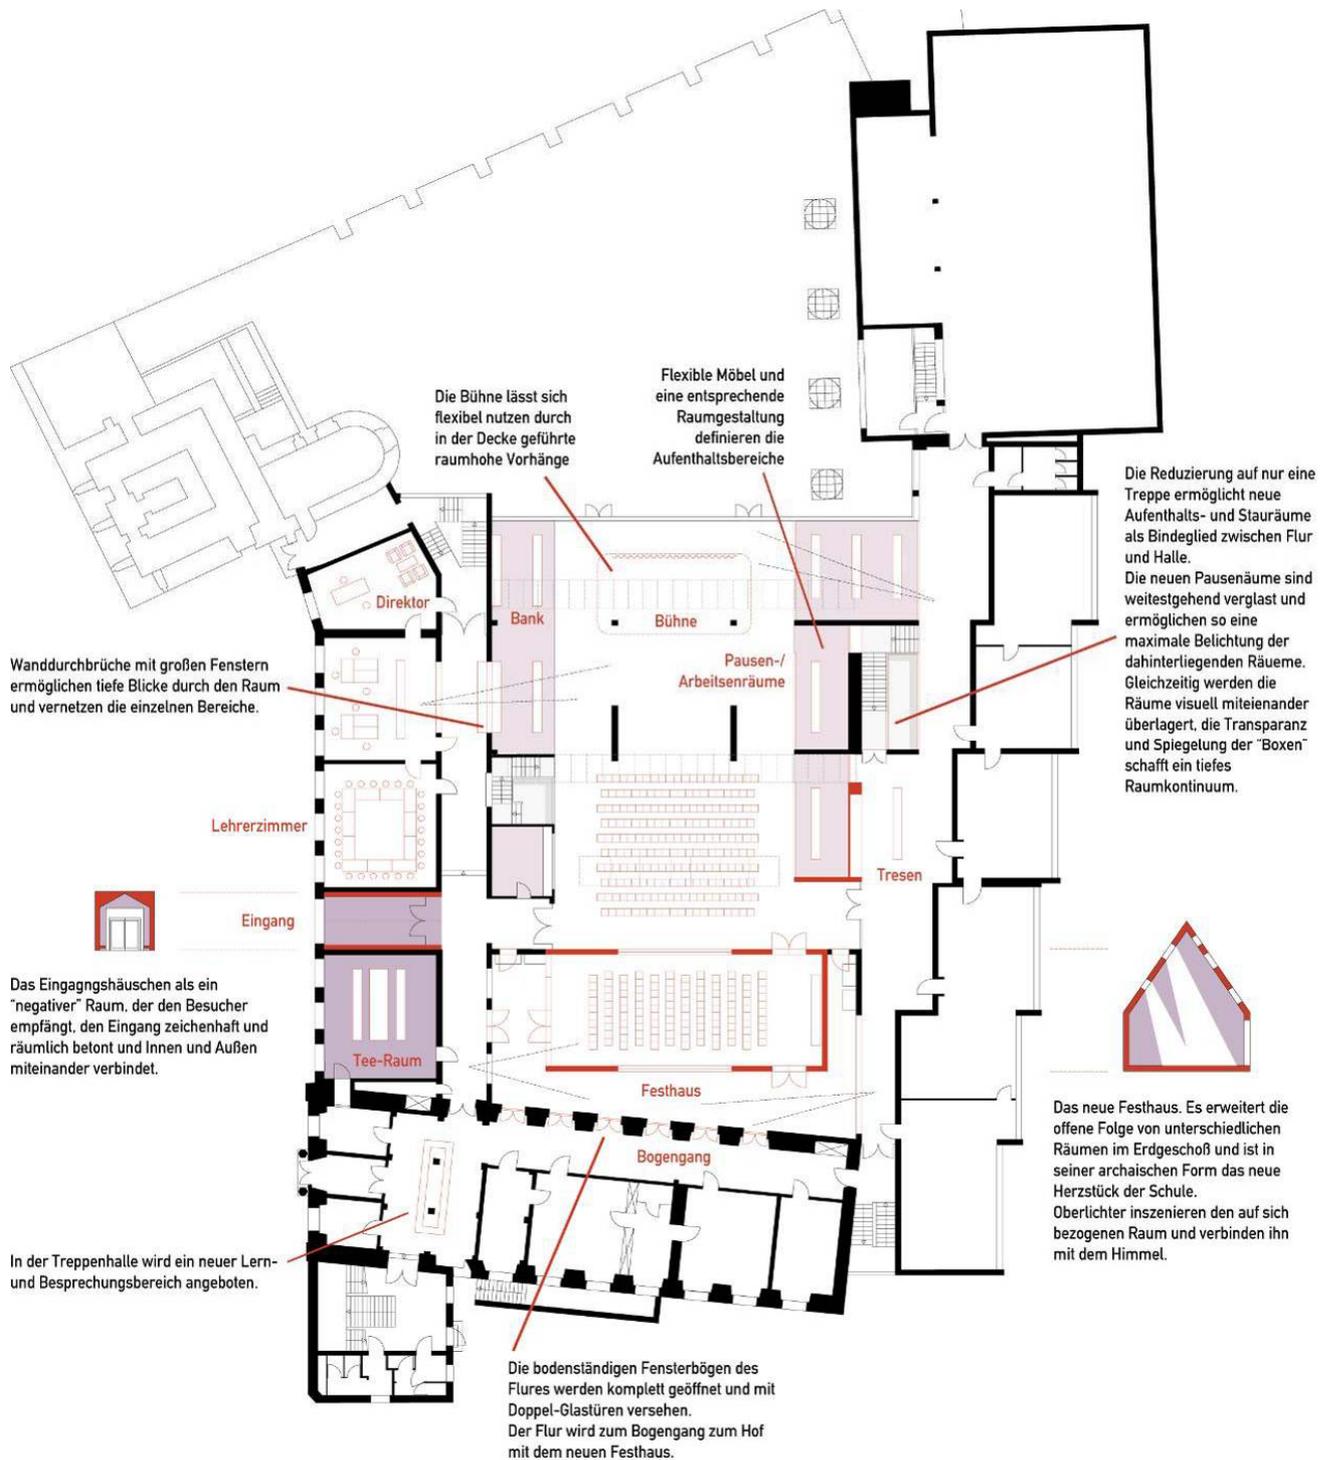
Grundriss EG Hildesheim, Maßnahmen
